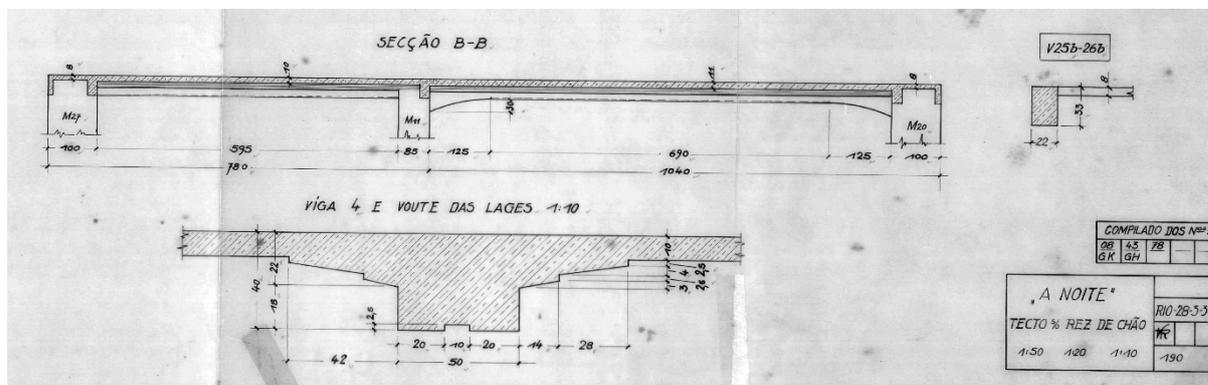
Detalhe do projeto de cálculo estrutural do ed. A Noite – teto do pavimento Rez do Chão
